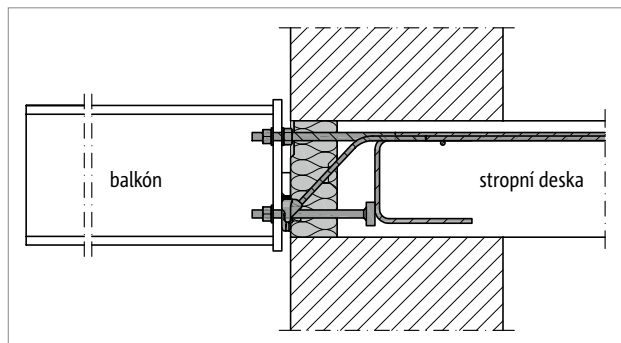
Schöck Isokorb® T typ SKP-WU-M1: Atypická konstrukce pro napojení na stěnu u prvků s třídami únosnosti ve smyku -V1 nebo -V2 pro tloušťku stěny od 200 mm
